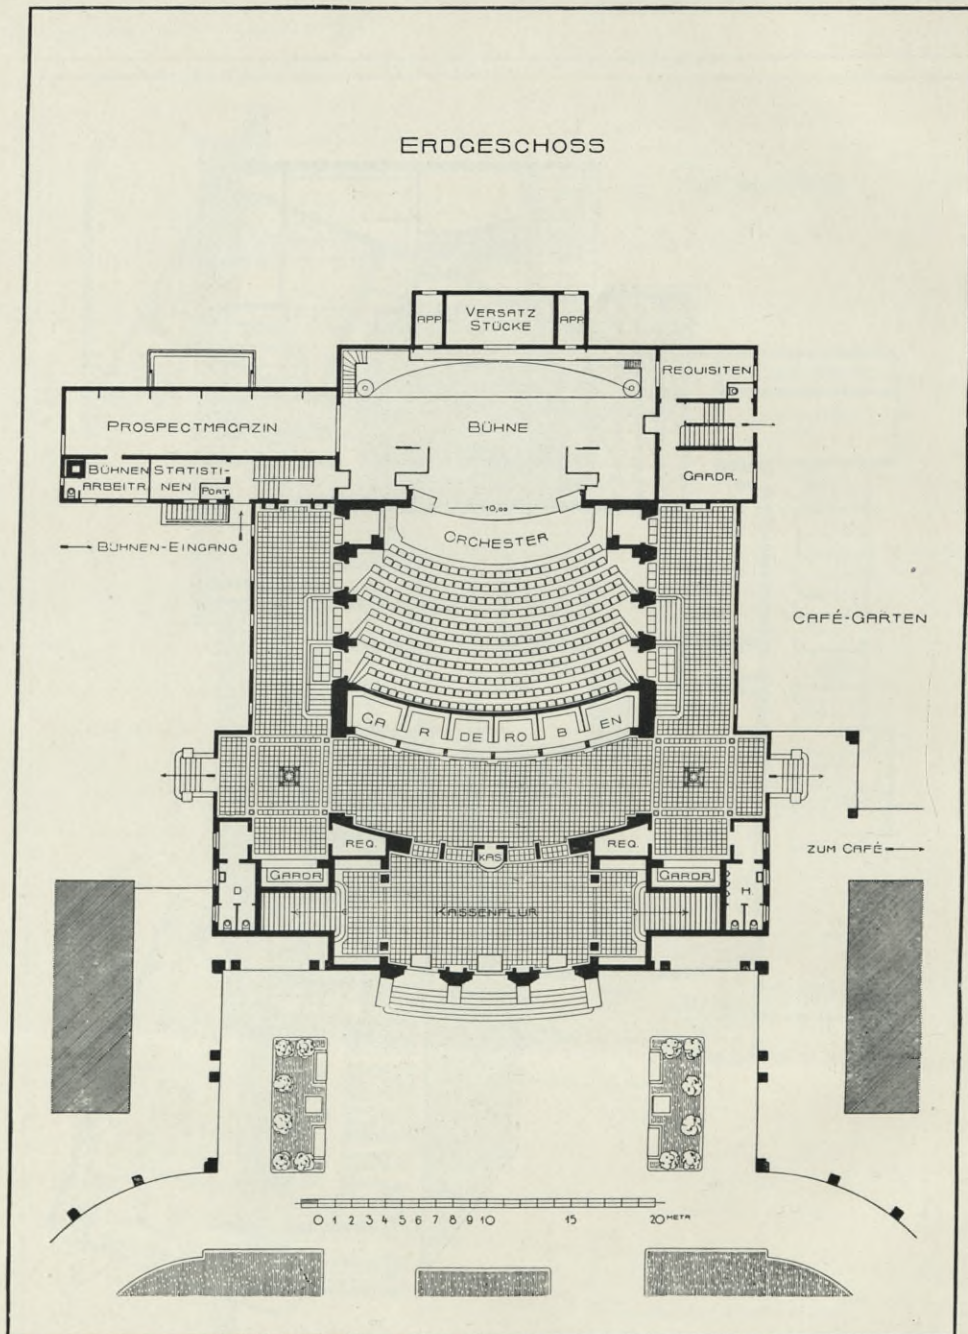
Künstler-Theater zu München. <sup>121)</sup> Grundriß Erdgeschoß.
